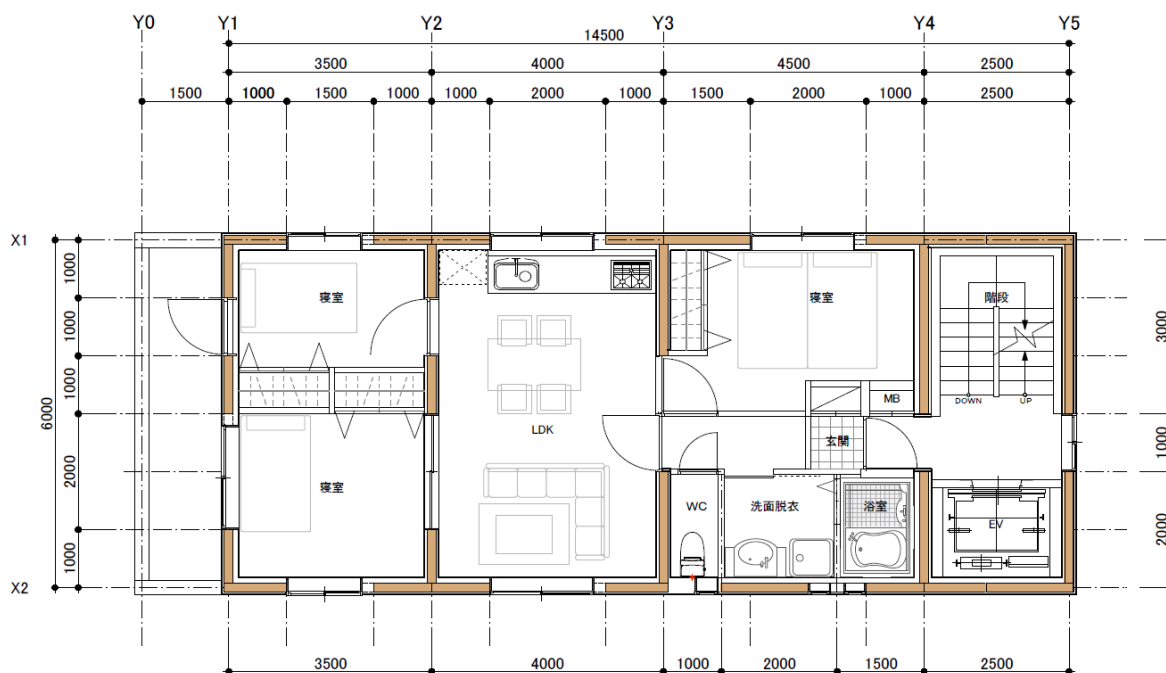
A 棟(5 層)試験体の基準階平面図
